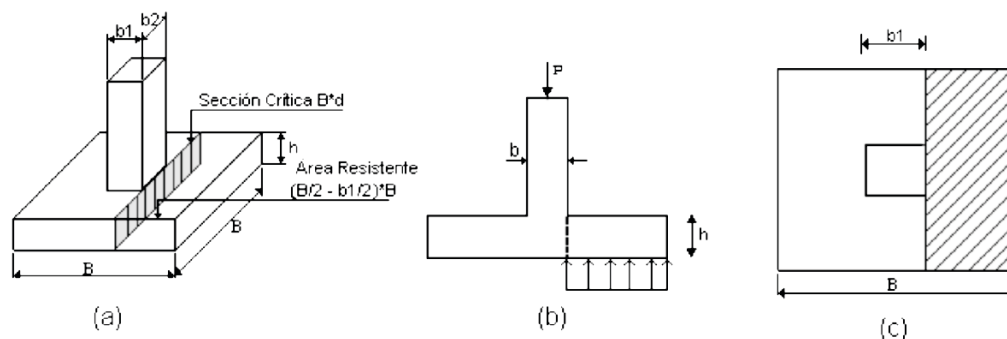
E SECCIÓN CRÍTICA PARA EL CÁLCULO DEL MOMENTO EN ZAPATA QUE SOPORTA COLUMNA, PEDESTAL O MURO DE CONCRETO
